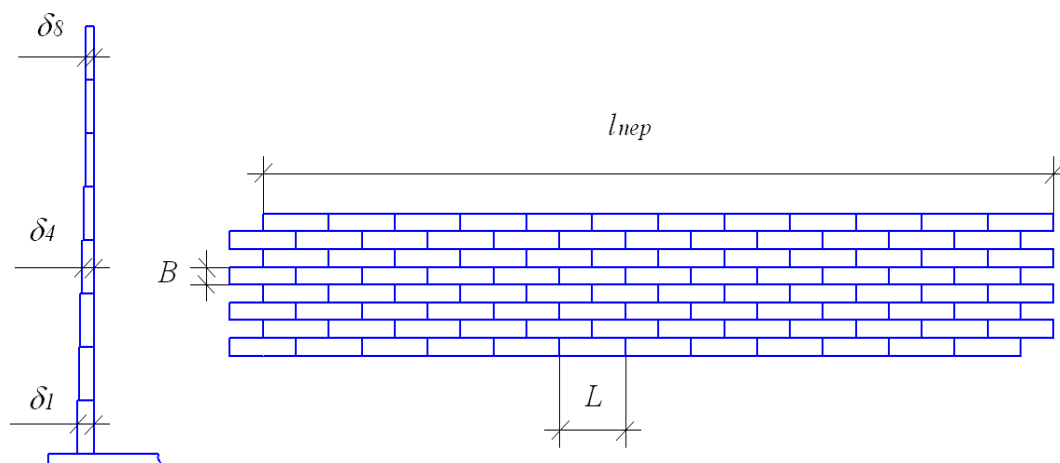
Развертка в сечении стенки вертикального резервуара
